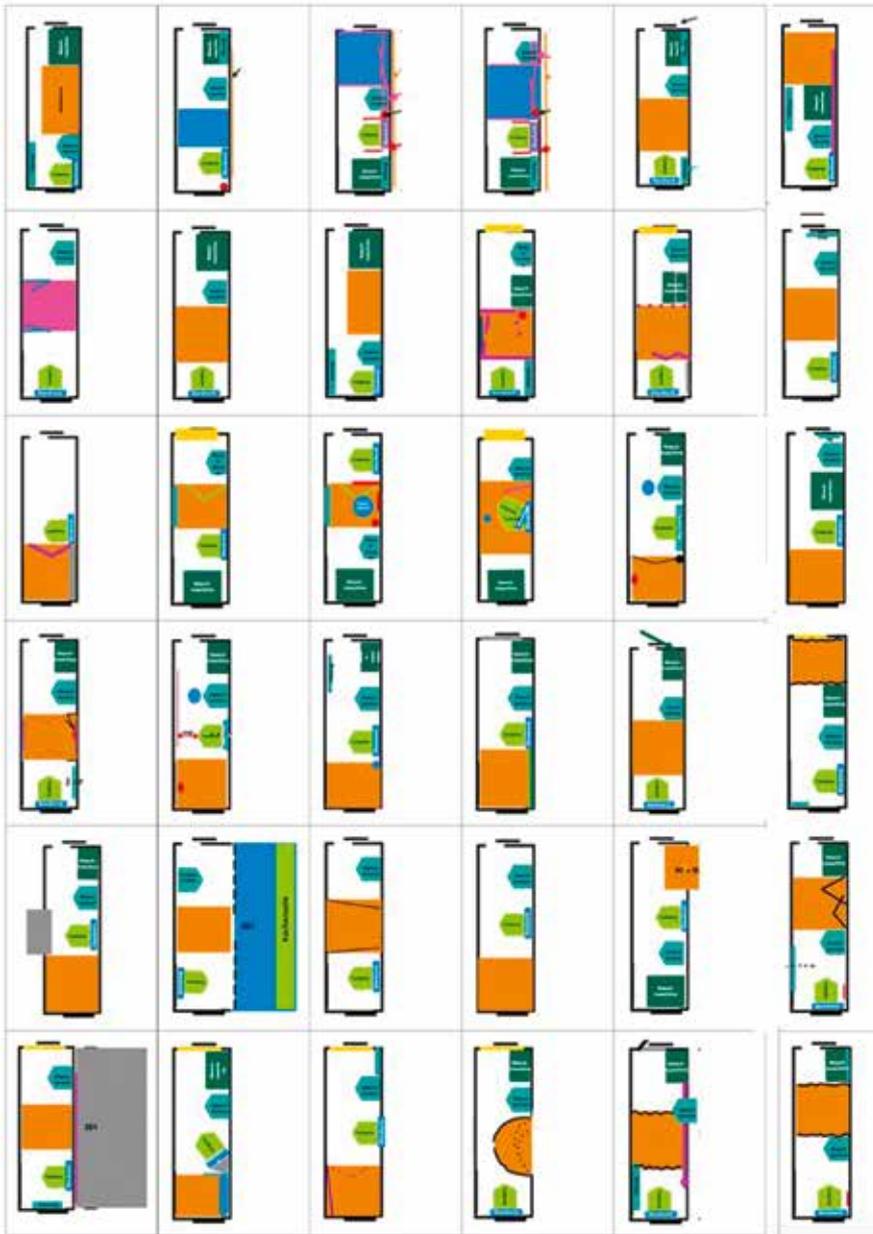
Grundrissvarianten zum Schlauchbad aus den Workshops
